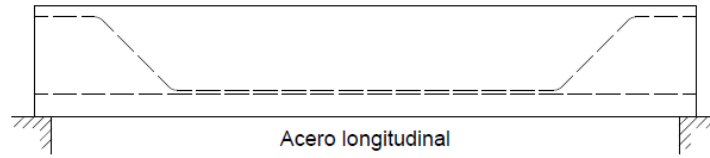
4 Viga reforzada a cortante con acero longitudinal doblado hacia arriba.
